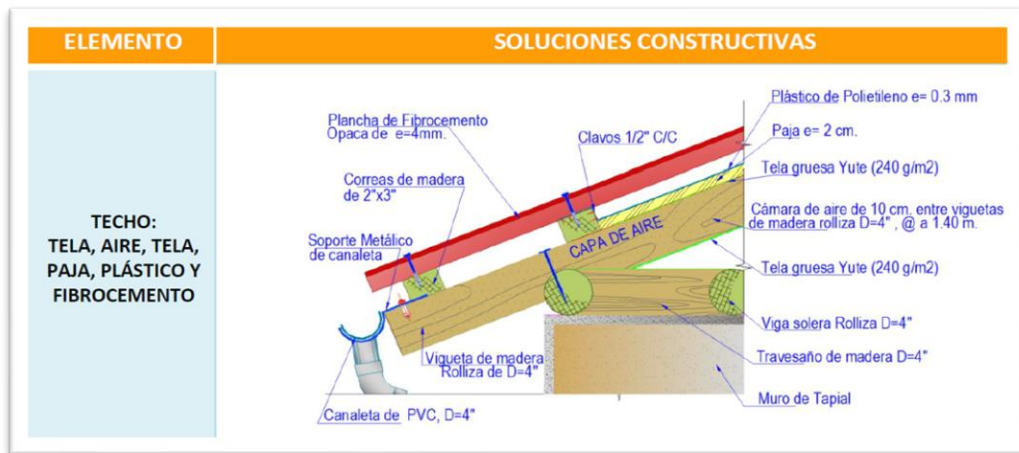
planos de los detalles en las cubiertas de la vivienda.
